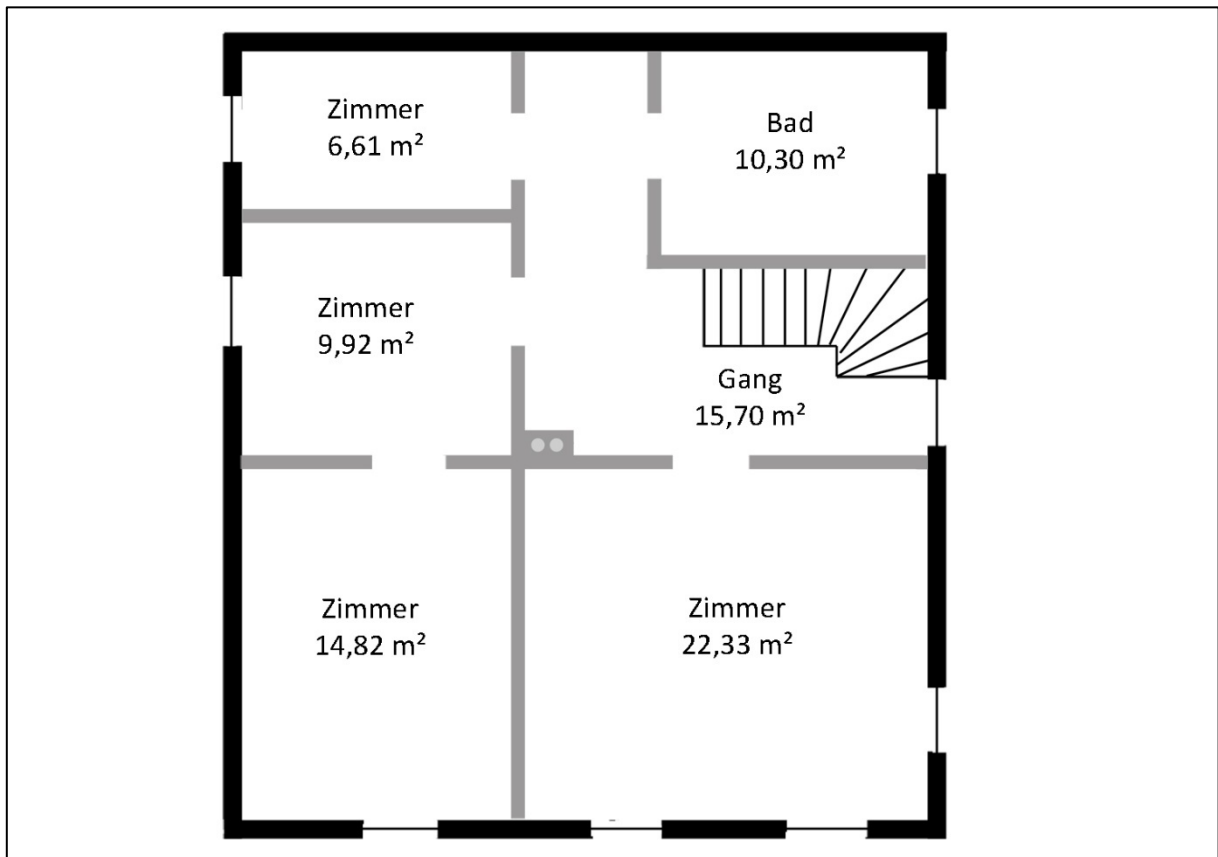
schematischer Grundriss des Obergeschoßes; Die Nettonutzfläche beträgt ebenfalls knapp 80 m², die über eine zentrale Stiege zugänglich sind.
